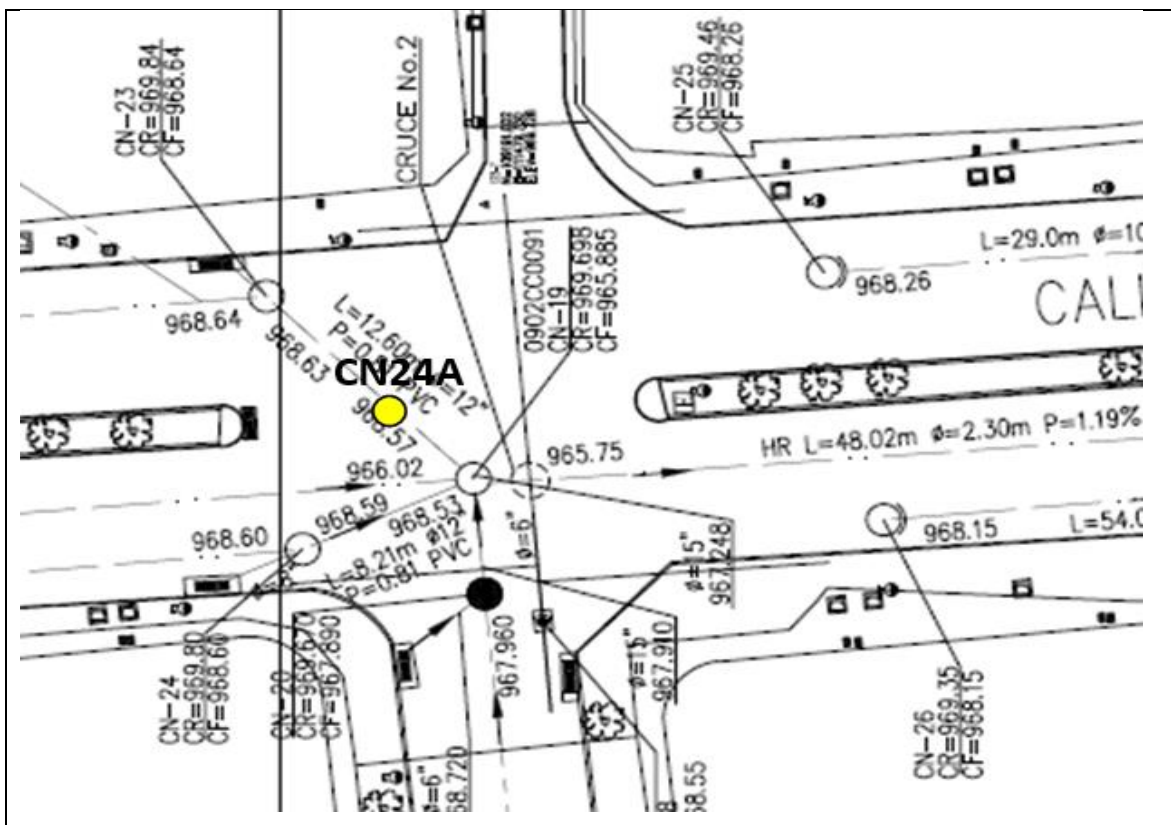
Instalación tubería de 12" entre cámaras tipo B CN24-CN22 en la calle 11 entre carrera 19 y 18.
